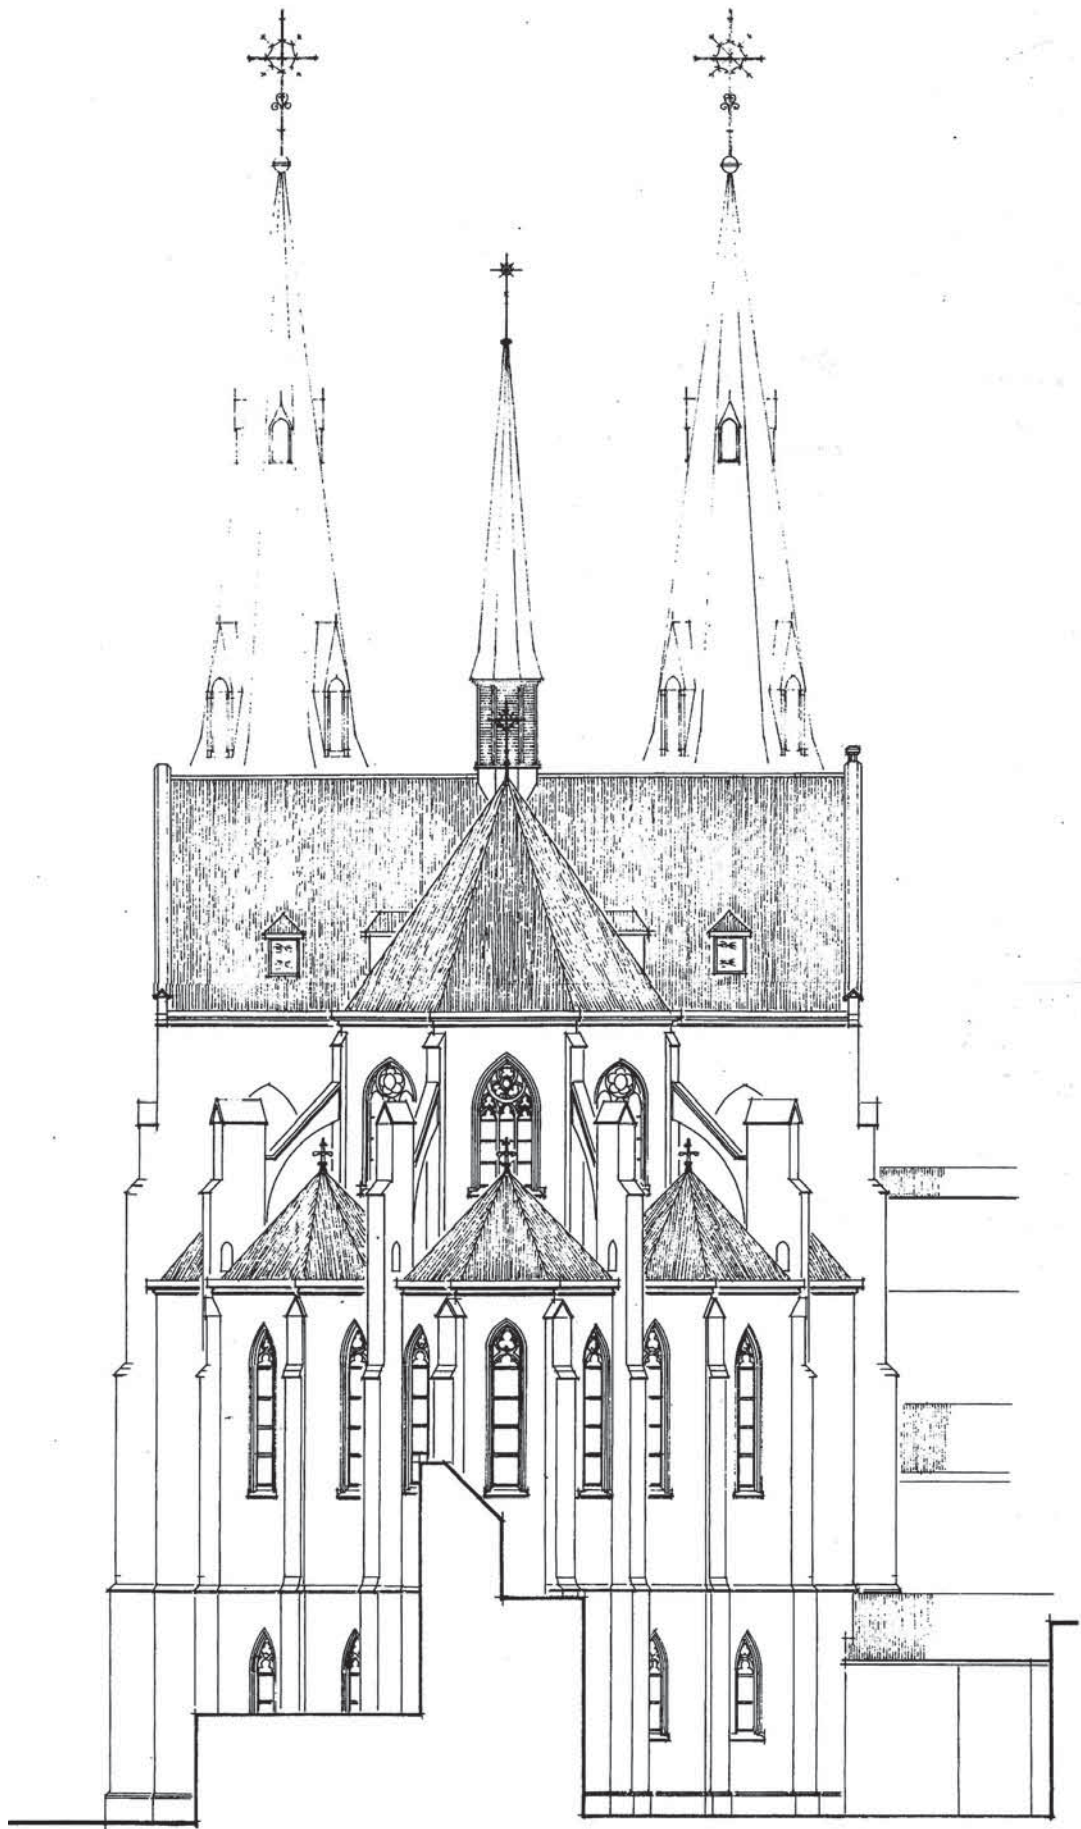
Aufriss Ostfassade, aufgenommen 1995 (Maßstab im Originalplan 1:100)
